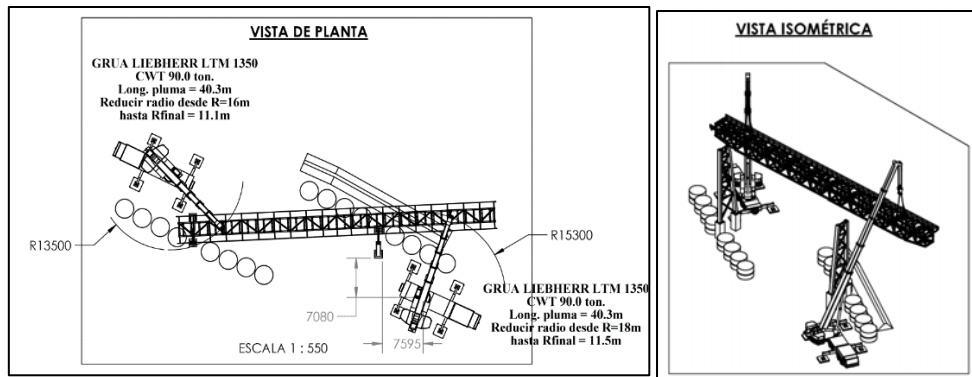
5 Rigging plan del Truss T6 – Faja CV201
